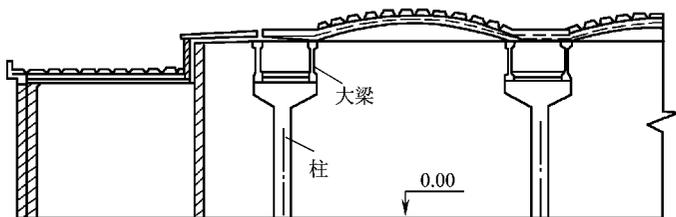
无技术夹层的钢筋混凝土结构无窗厂房
